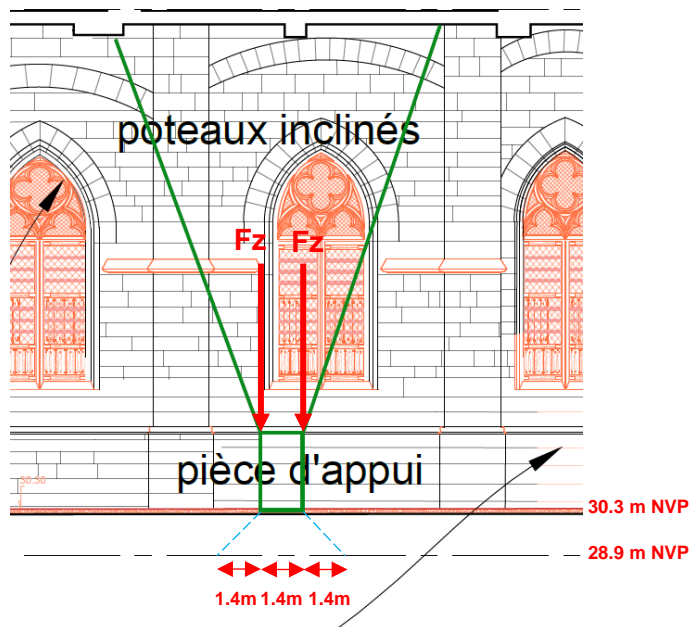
Principe de diffusion des efforts verticaux des poteaux le long de la façade contemporaine
